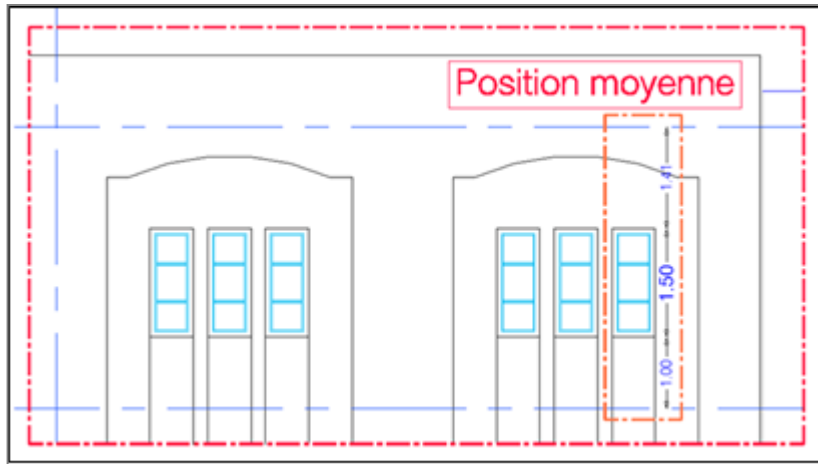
Exemple de la position des ouvertures sur le mur de la façade
